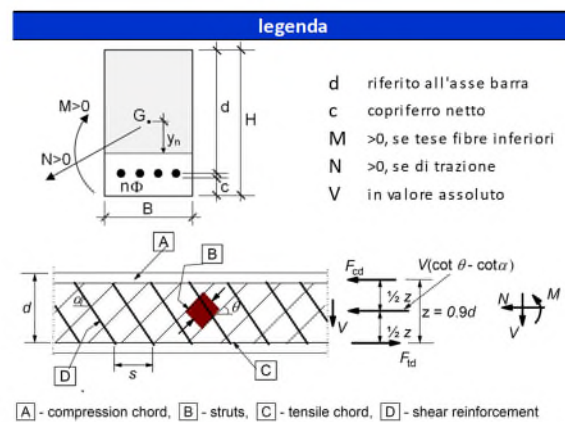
Verifica strutturale SLU - Sezione 1
